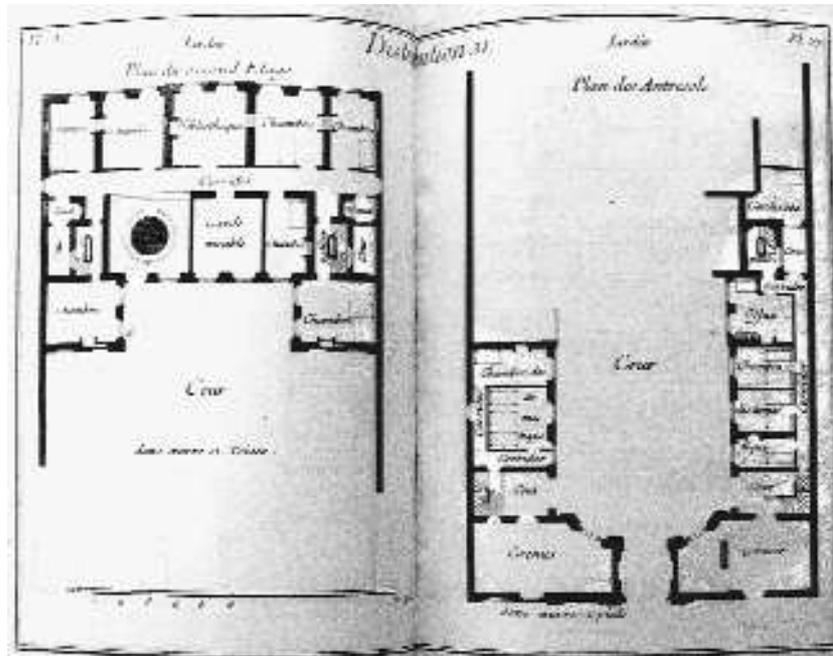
Anonym, Stadtpalais, Grundrisse des zweiten Geschosses und Mezzanin, 1728/29
